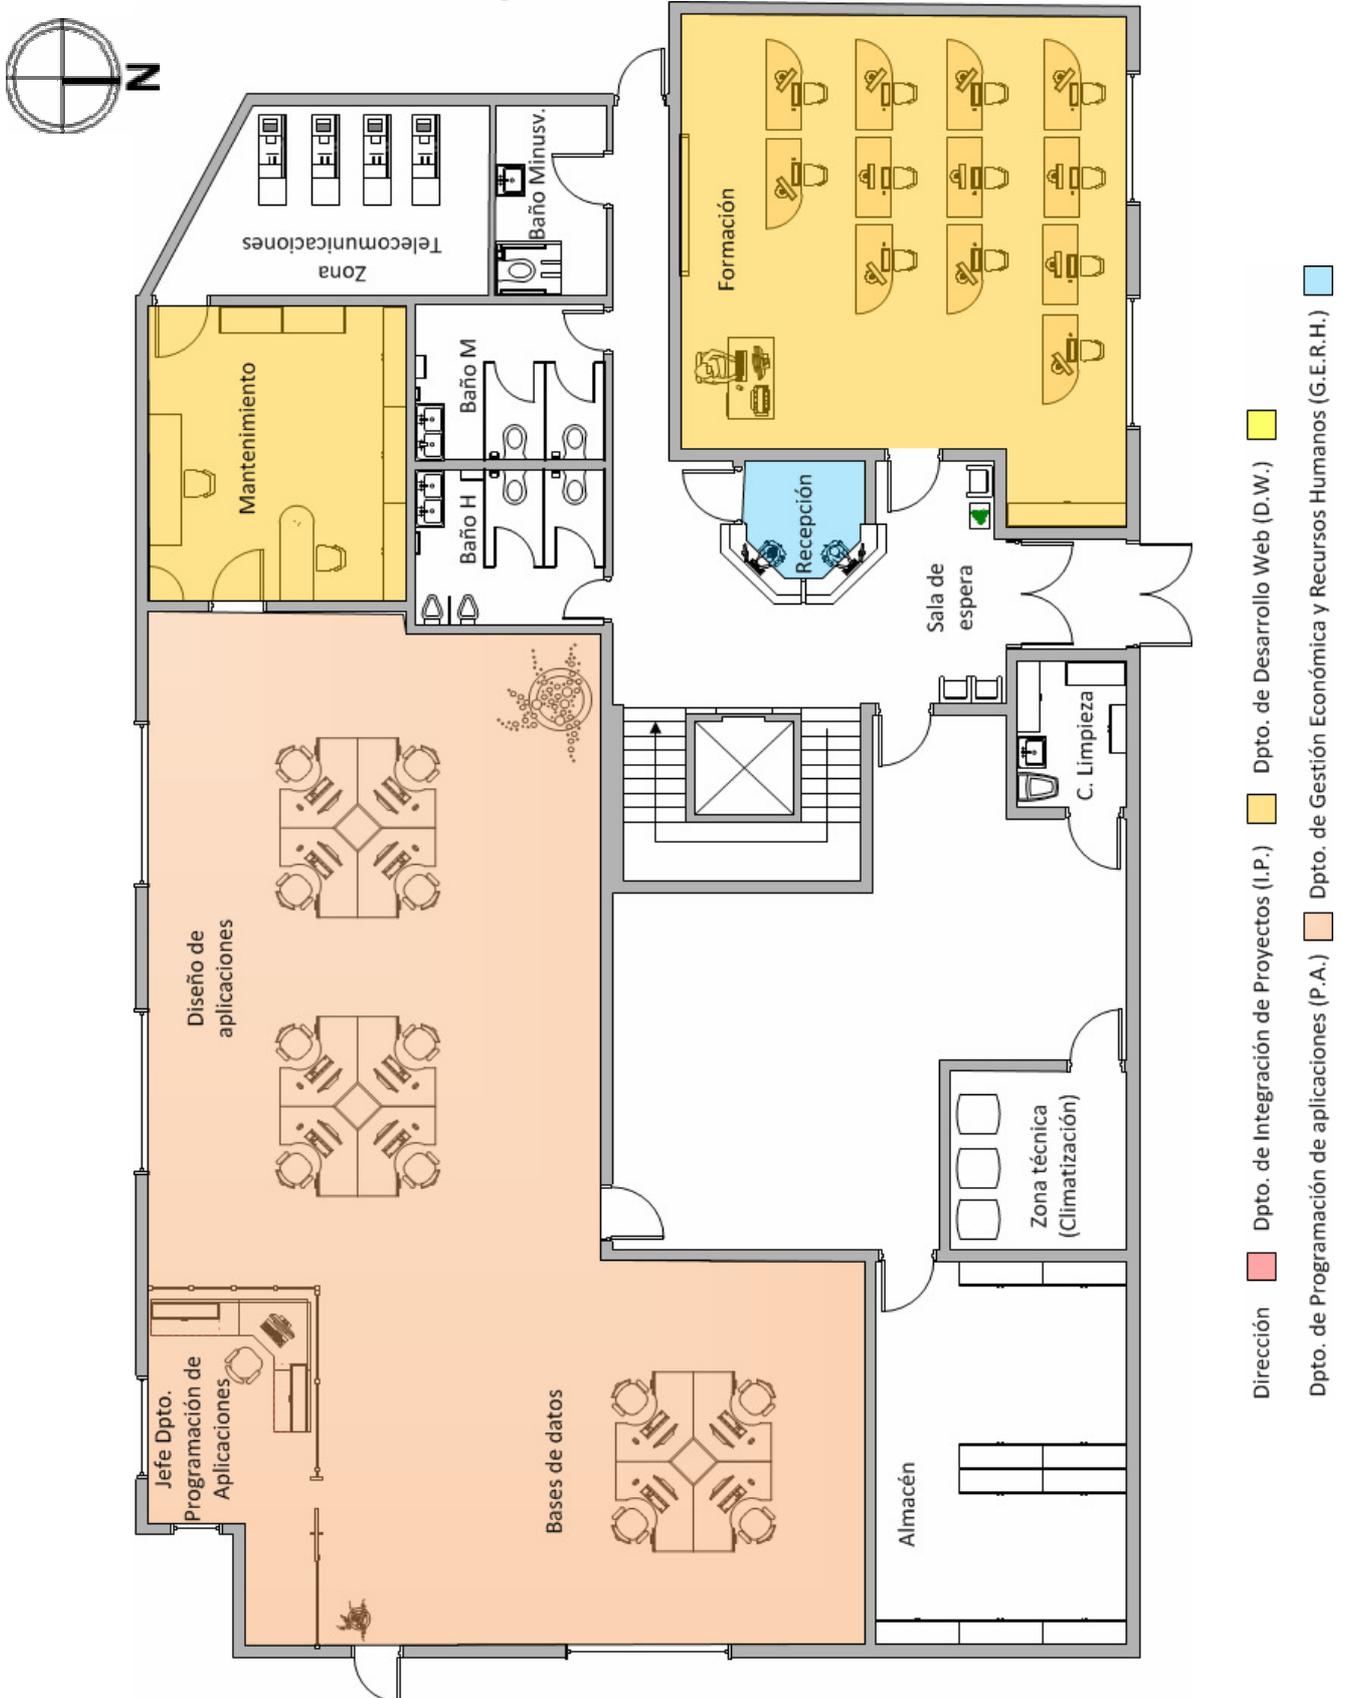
Distribución de las instalaciones de la Planta Baja
